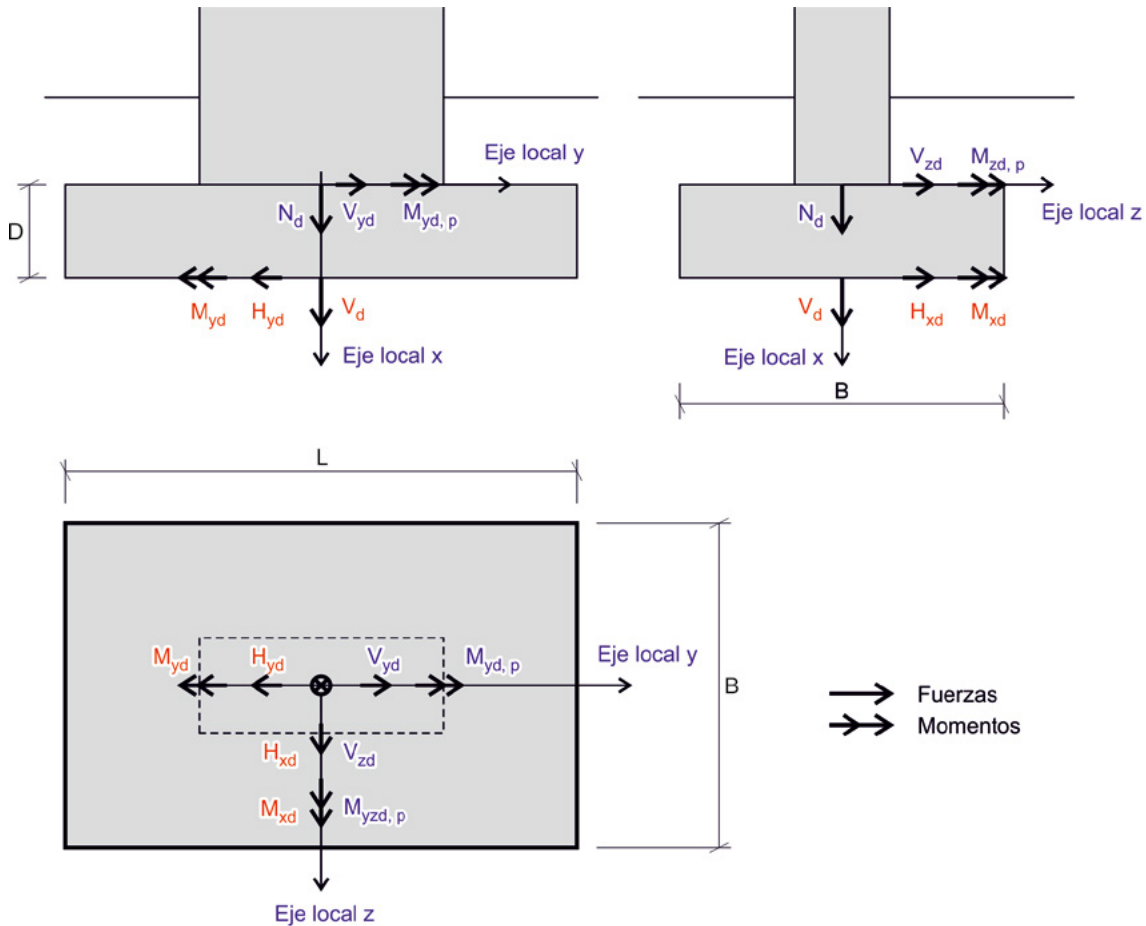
Esfuerzos transmitidos por el tablero a la base de pila (cara superior de zapata) y esfuerzos actuantes en el plano de cimentación, cada uno referido a su sistema de ejes
